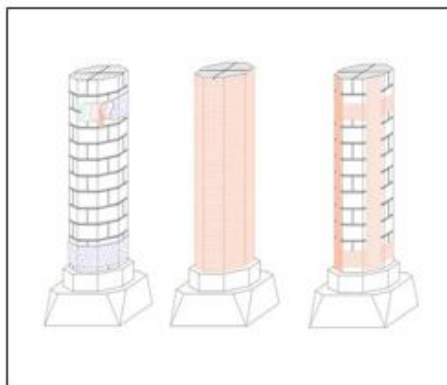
Tipos de refuerzos con FRP en pilastras.
